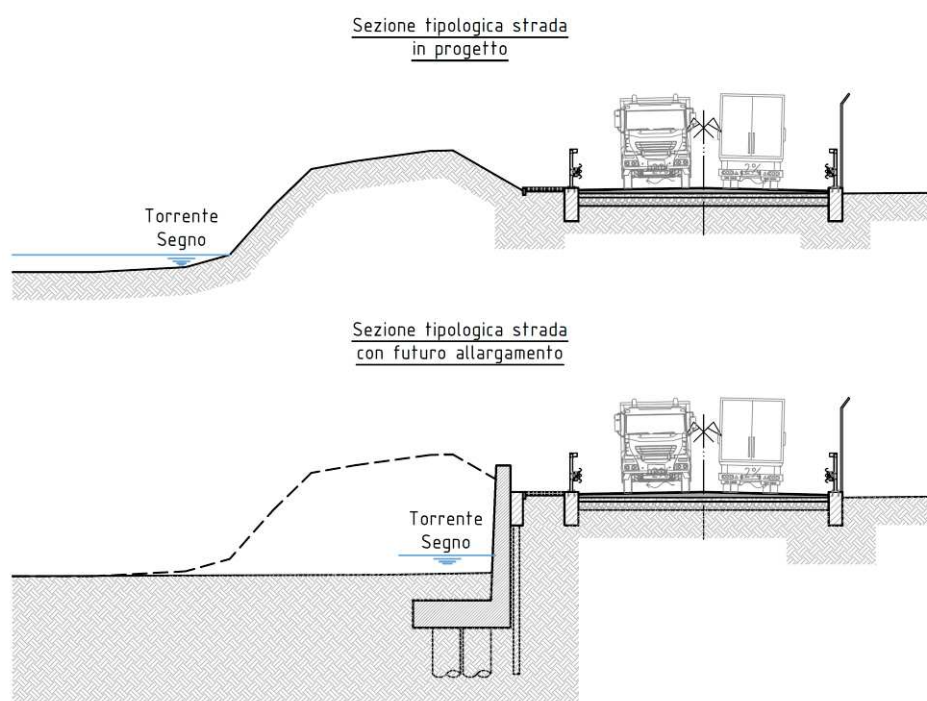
Sezione tipologica della nuova strada nella configurazione con T. Segno allargato a confronto con quella di progetto
